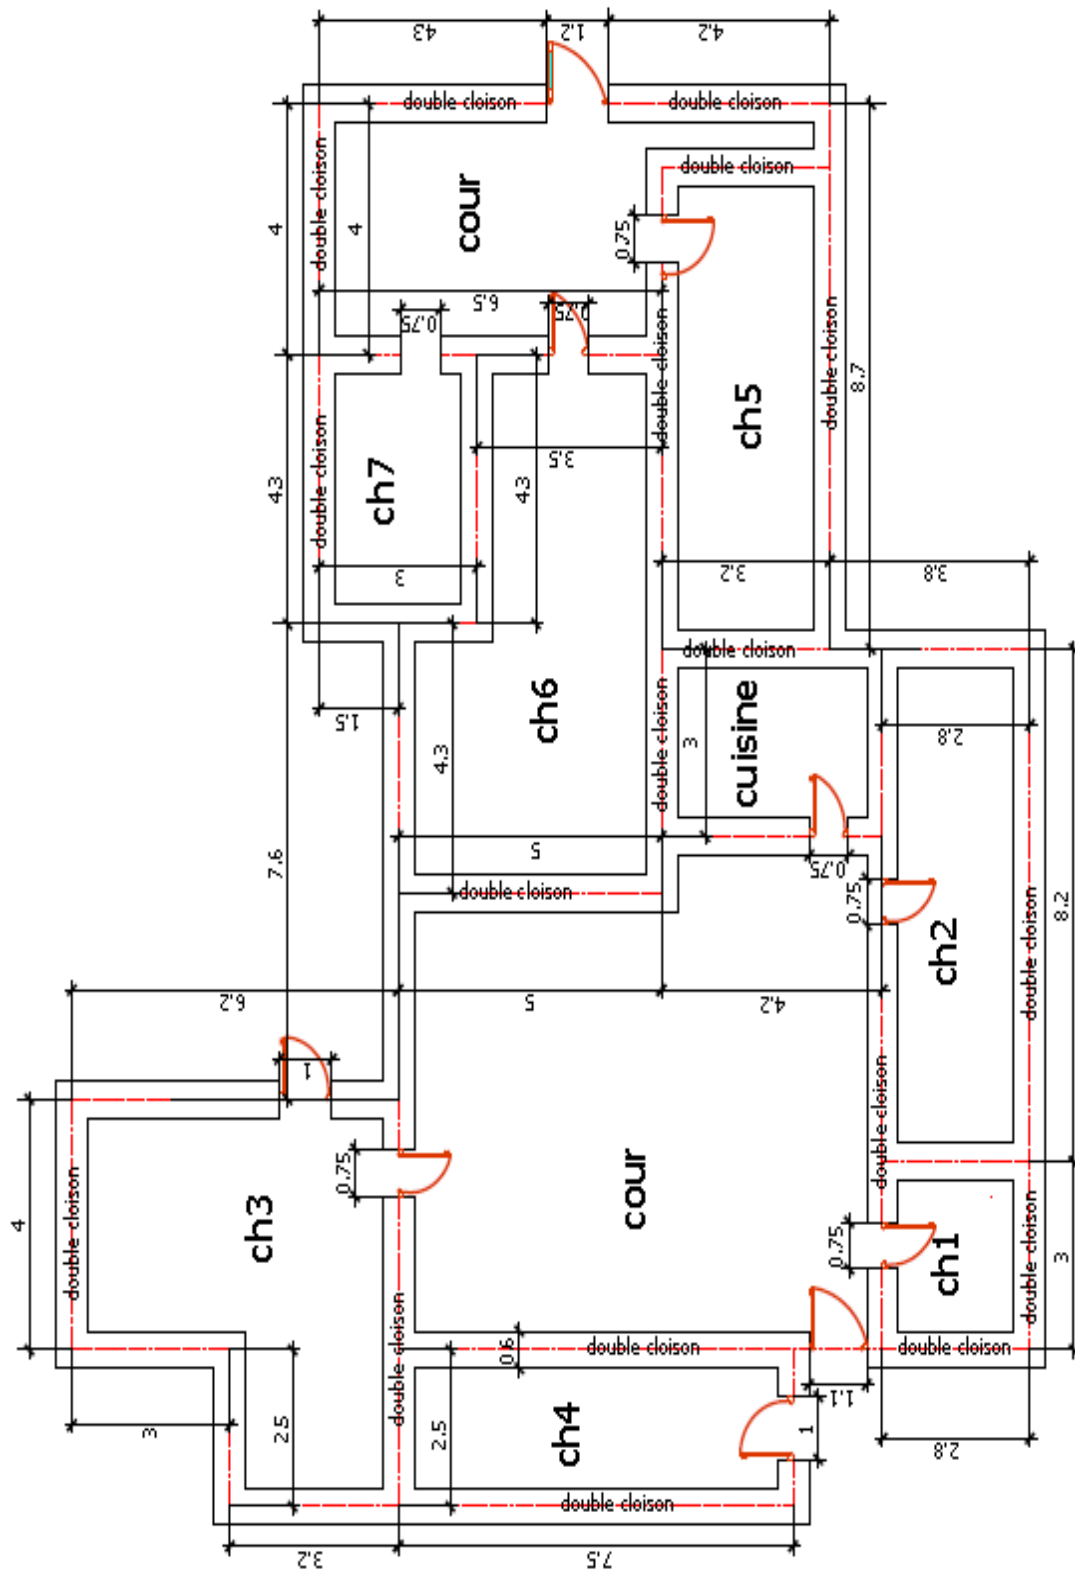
Plan RDC d'une maison en brique de terre (Dessin Autocad SAADAoui Benaceur, OUAHAB Yamina).
